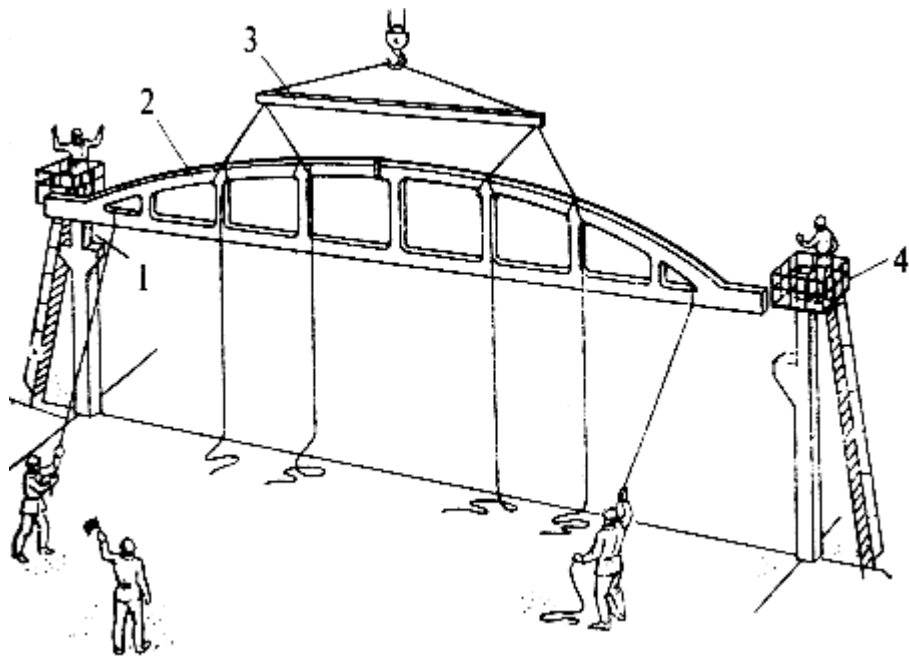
Установка та закріплення ферми на опорних площинах колон [27]
